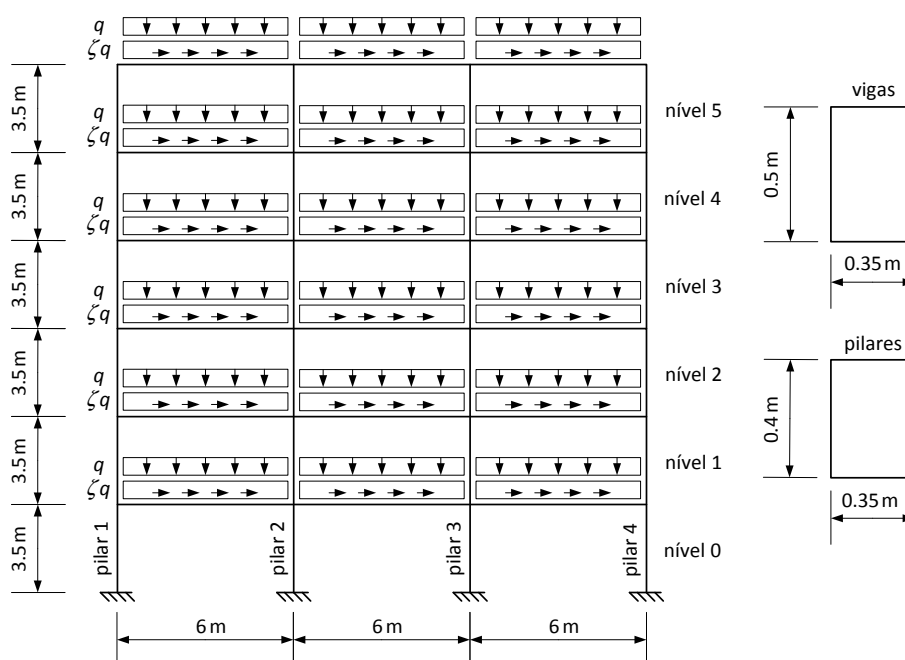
Exemplo de aplicação: geometria do pórtico e forças aplicadas.
